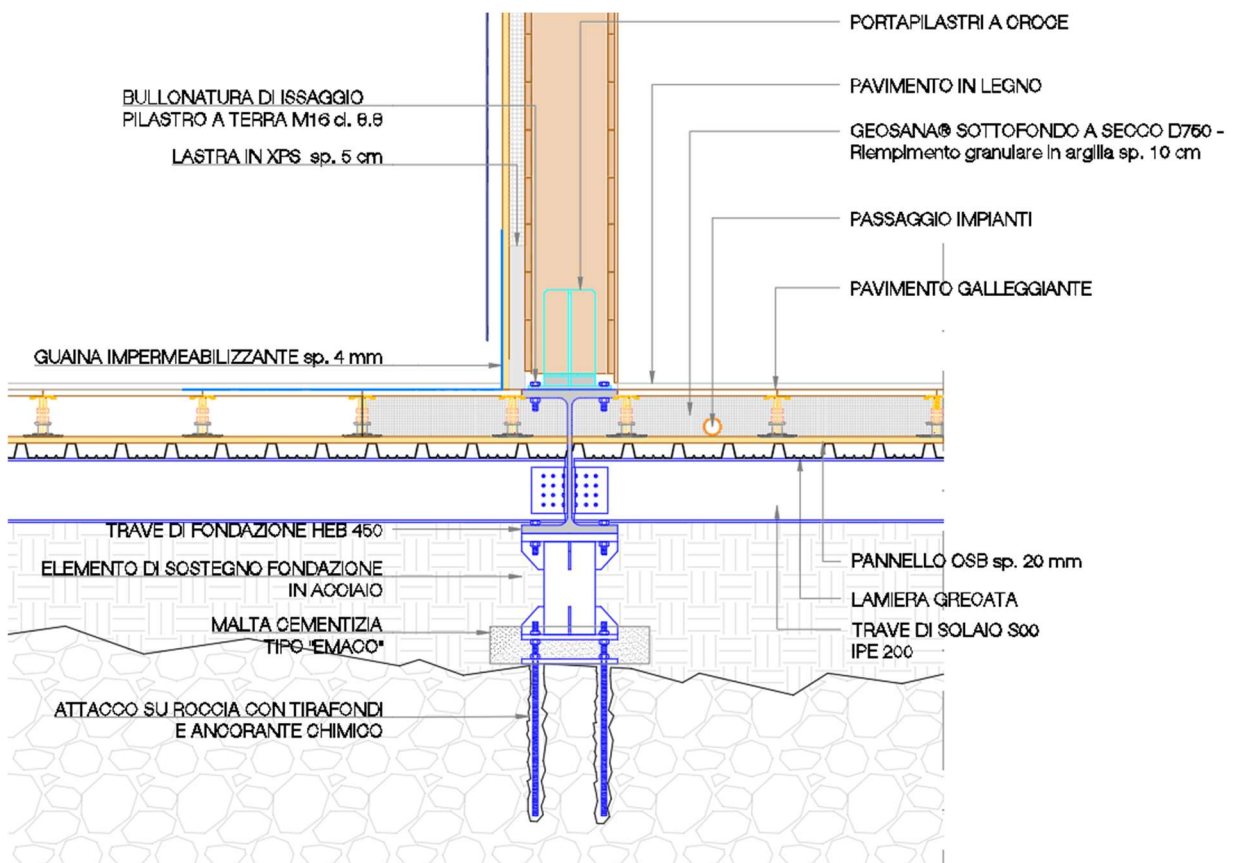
Sezione tipo di fondazione a secco realizzata elementi puntuali in acciaio
